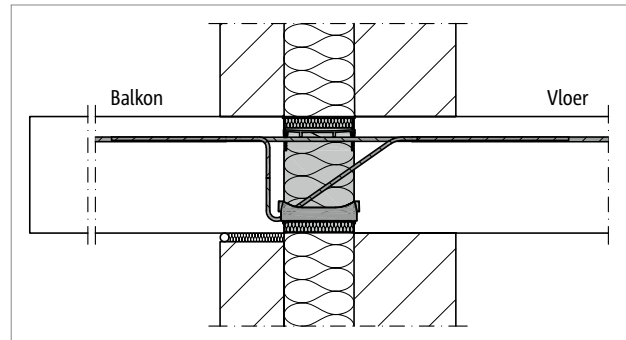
Schöck Isokorb® XT type K: Aansluiting bij geïsoleerd stucwerk
